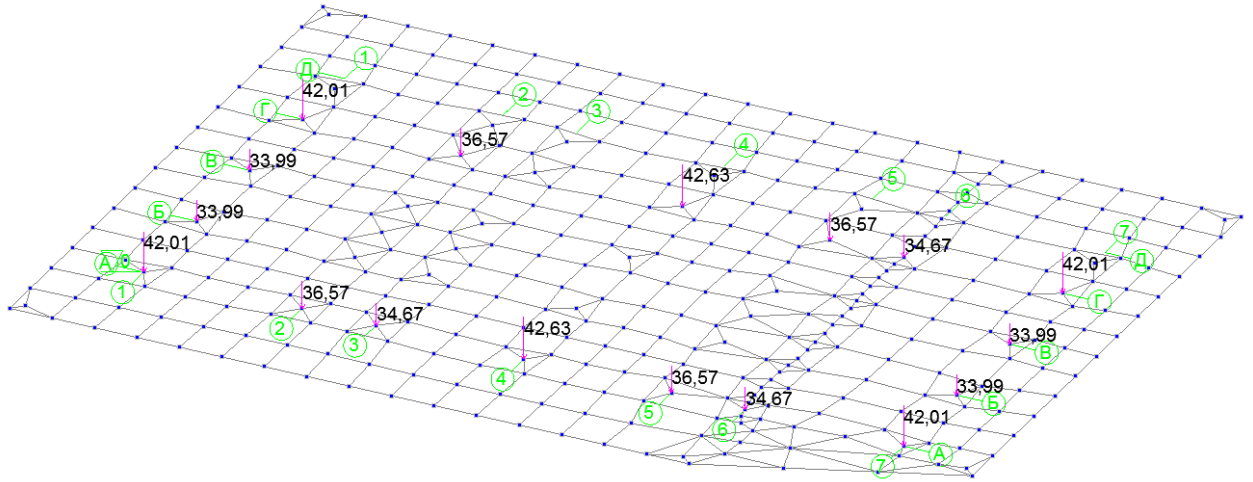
Постоянная нагрузка на фундаментную плиту от наружных стен.
